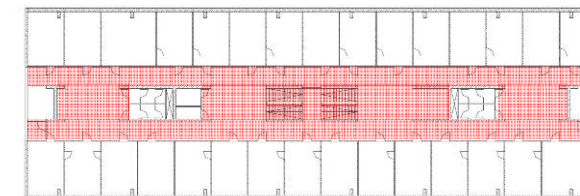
Regelgeschoss - Grundriss 2.0G
